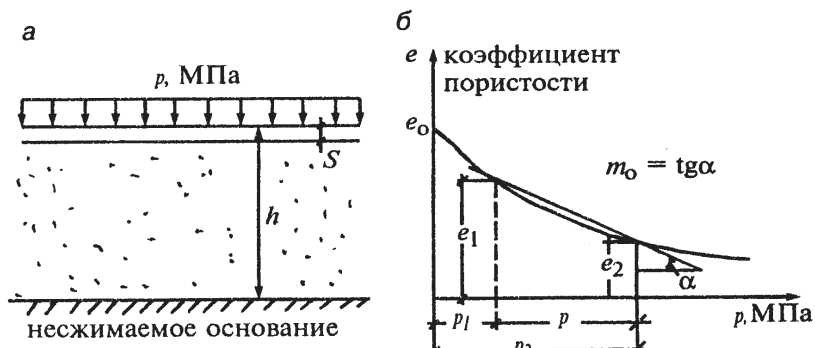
Схема сжатия грунта при сплошной нагрузке:
